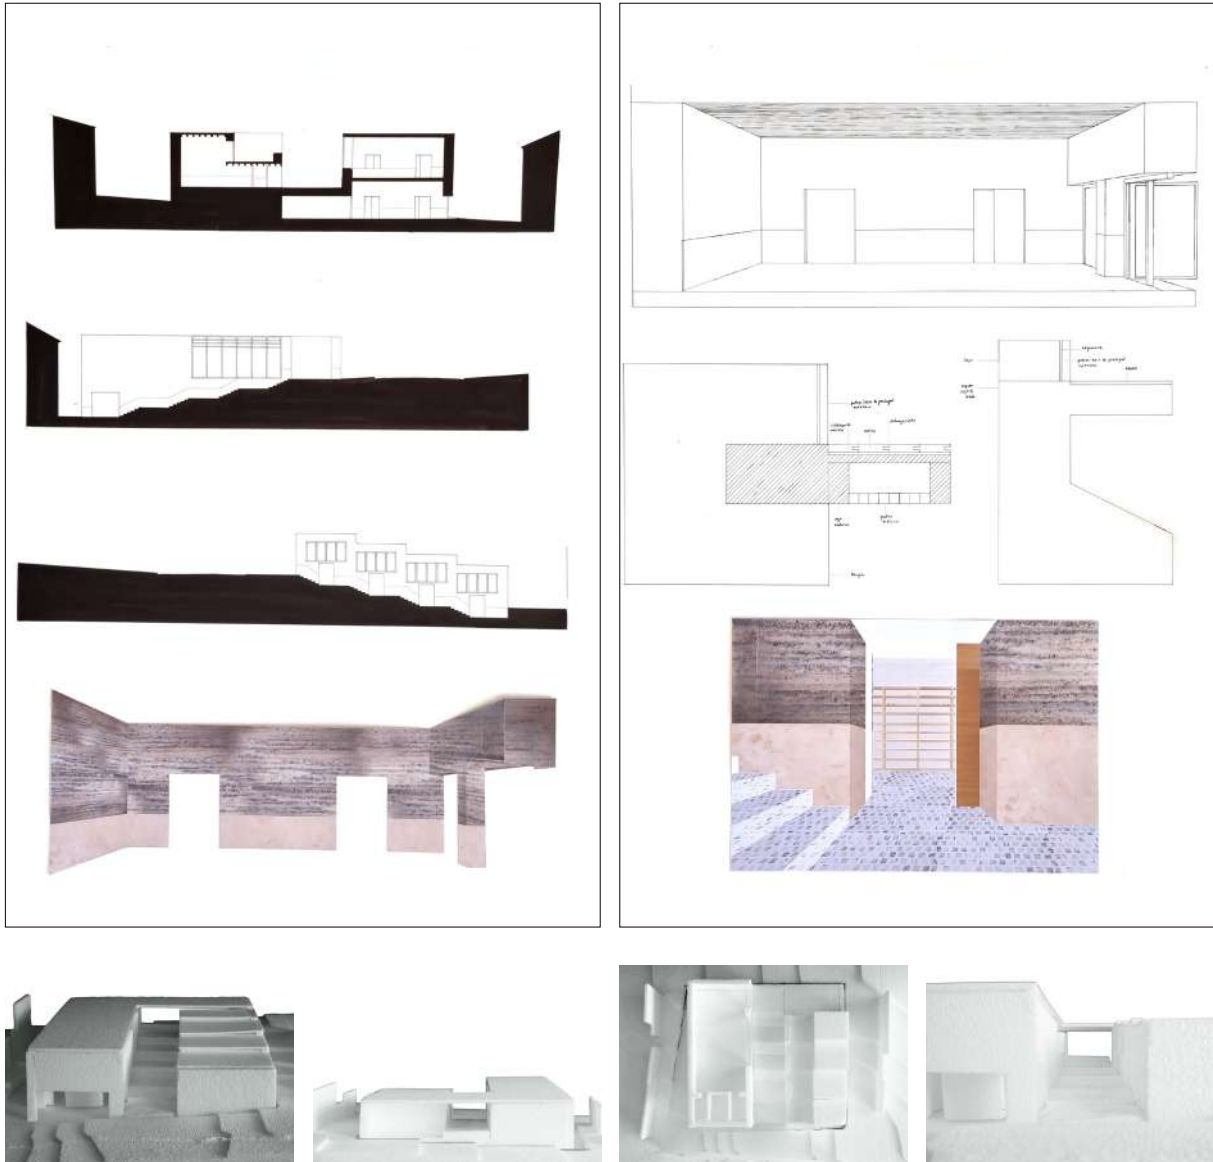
Digitalização de painel A1 composto por planta de implantação 1:2000 , alçados e planta a 1:200.
